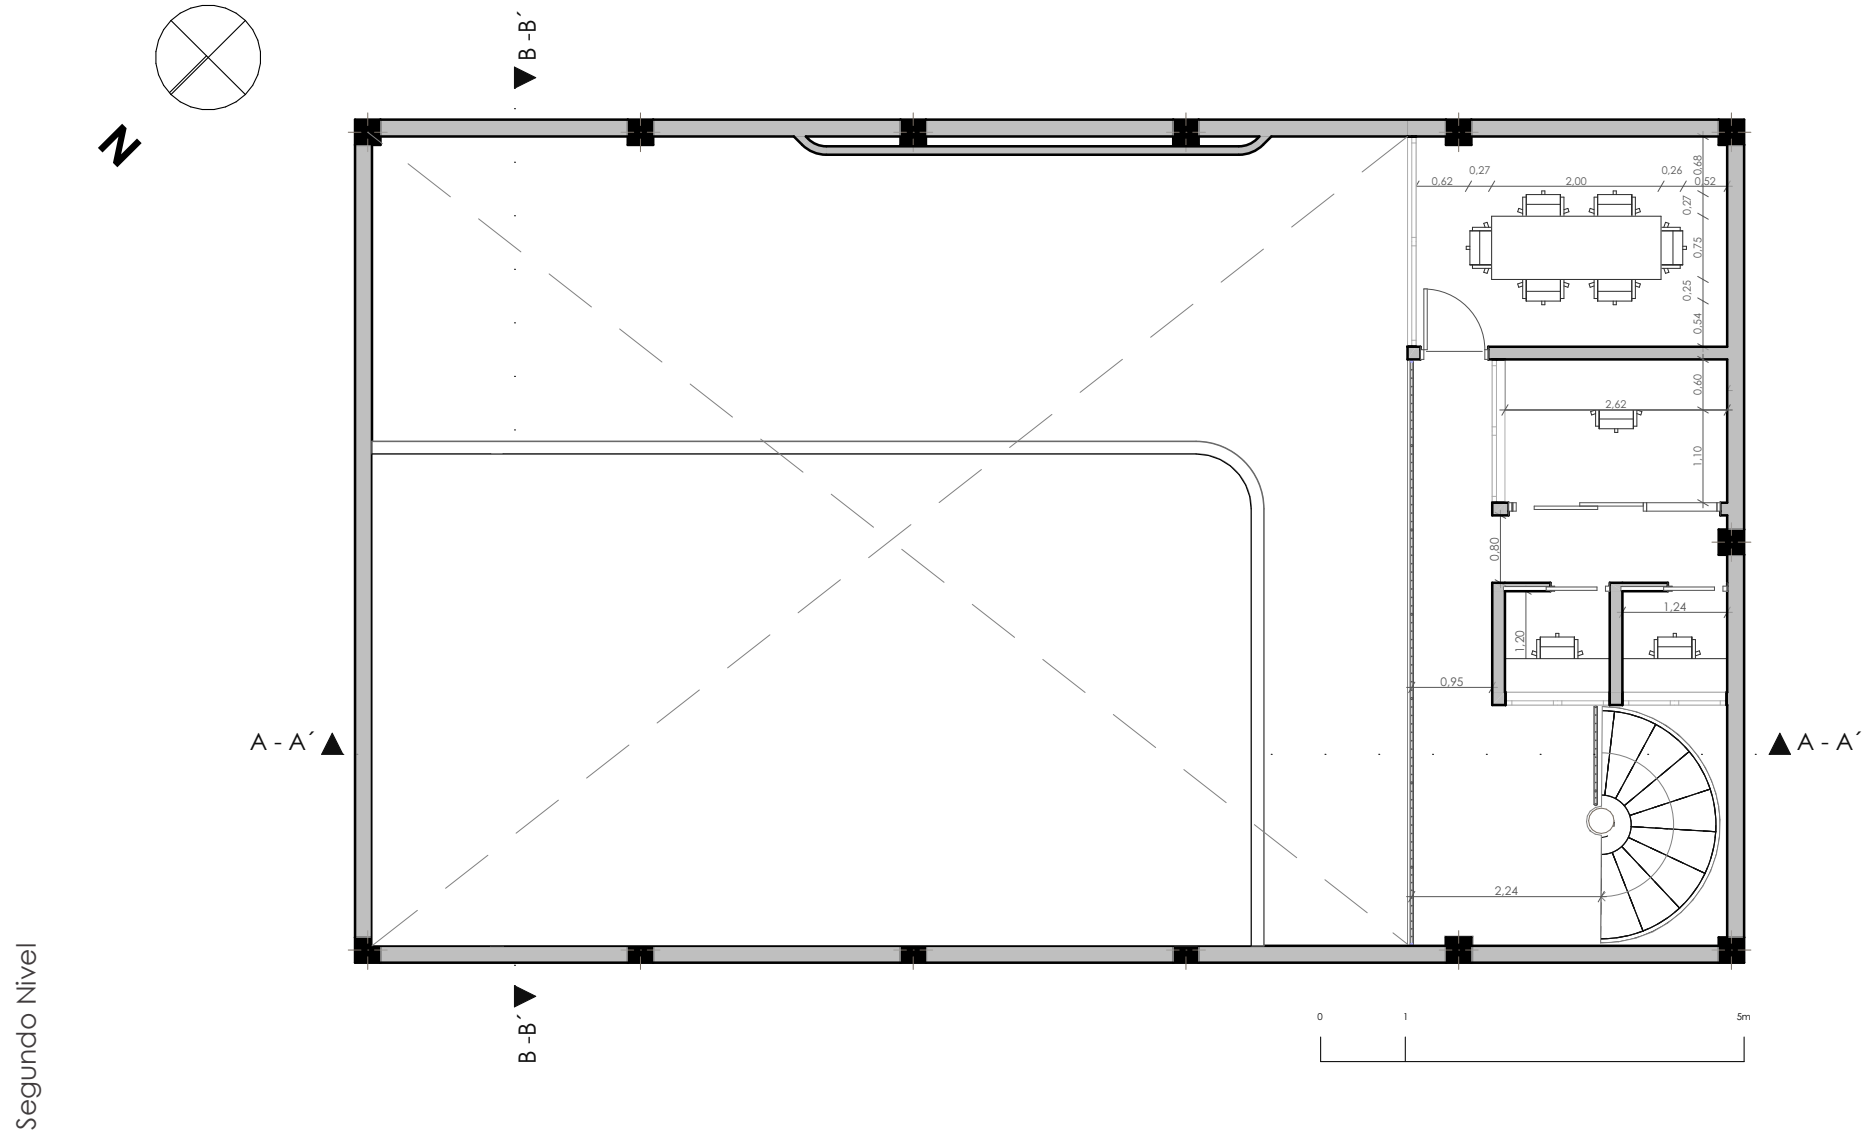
, Planta Arquitectónica Amoblada Planta Alta, Elaboración Propia.
